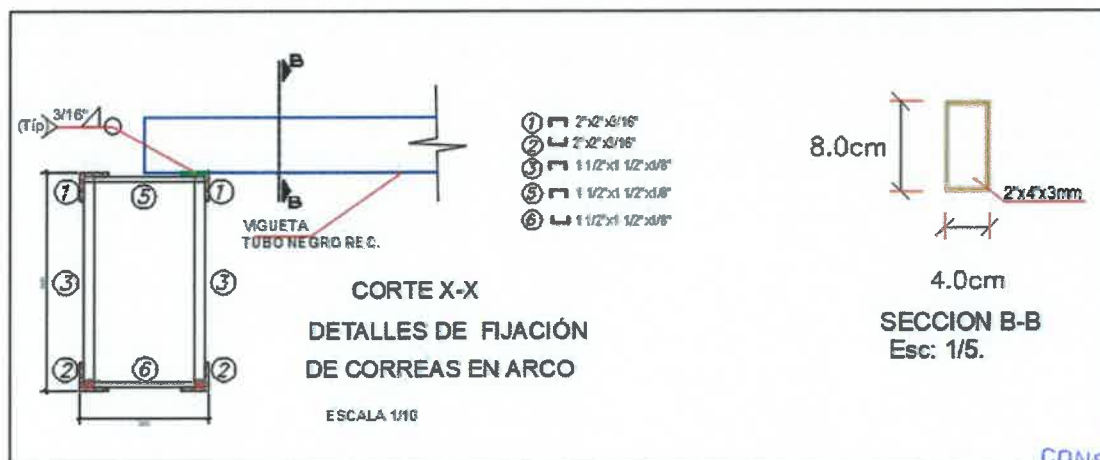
Vigueta longitudinal entre arcos metálicos.
